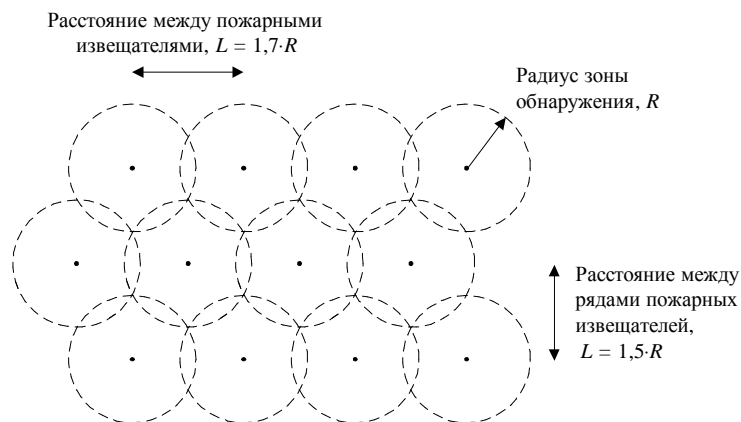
Схема размещения дымовых или тепловых извещателей по "треугольной решетке"
